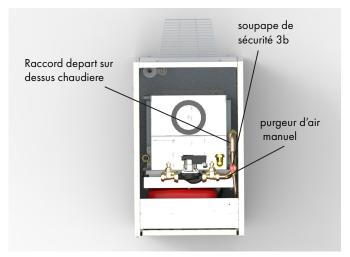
Assemblage pompe sur OutdoorS+ BN 24kW et 32kw
